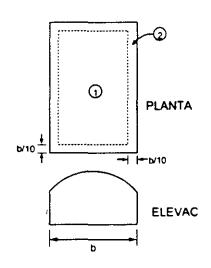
Elementos de recubrimiento en cubiertas en arco
